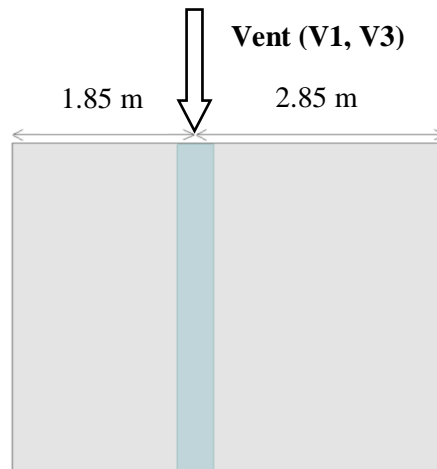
Surface reprise par le poteau le plus sollicité.
